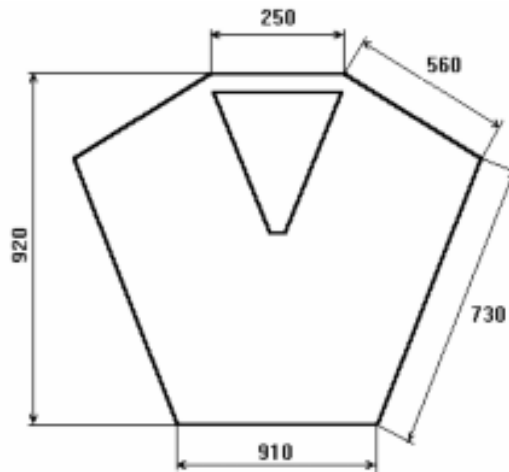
Dimensiones del bloque, cara frontal. Según [3]
